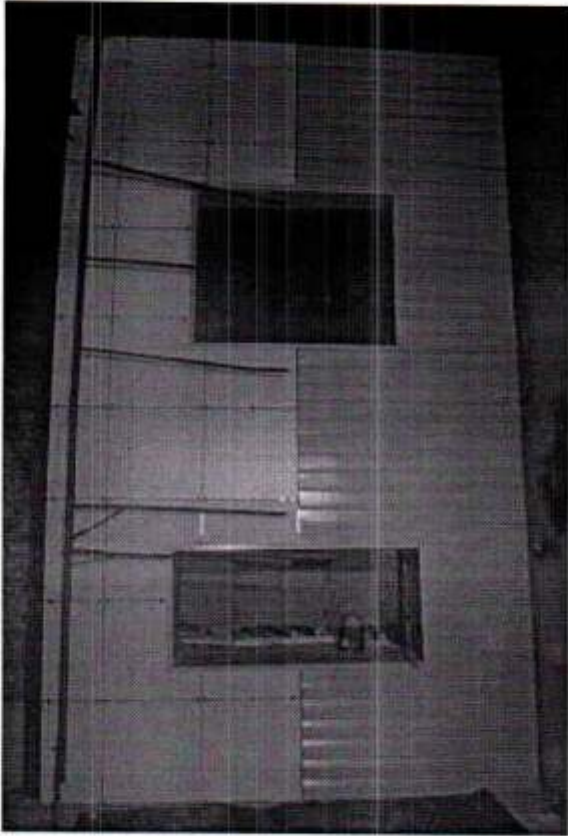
Б. Фрагменты образца фасада до испытания по ГОСТ 31251-2008.
